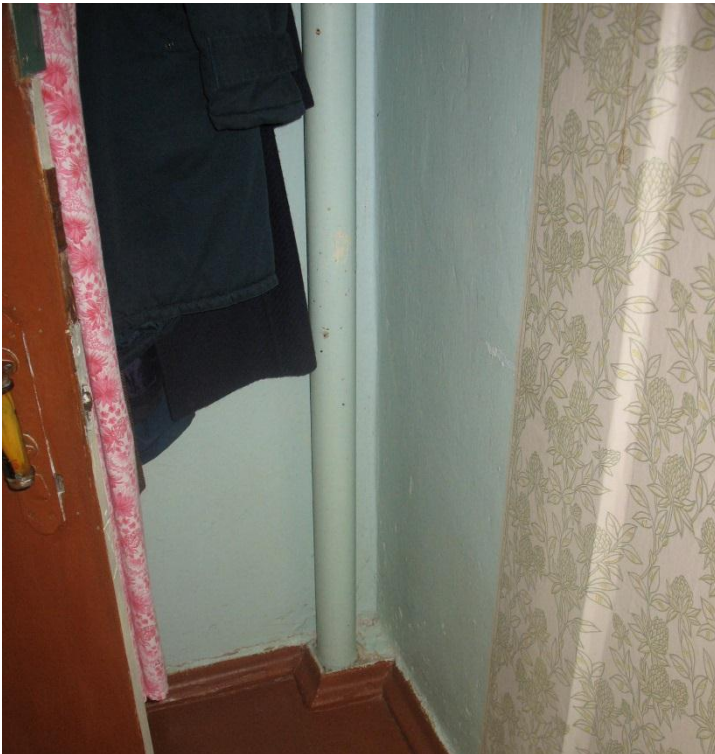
Транзитний подаючий трубопровід системи опалення будівлі, що піднімається із теплового пункту на останній поверх будівлі
